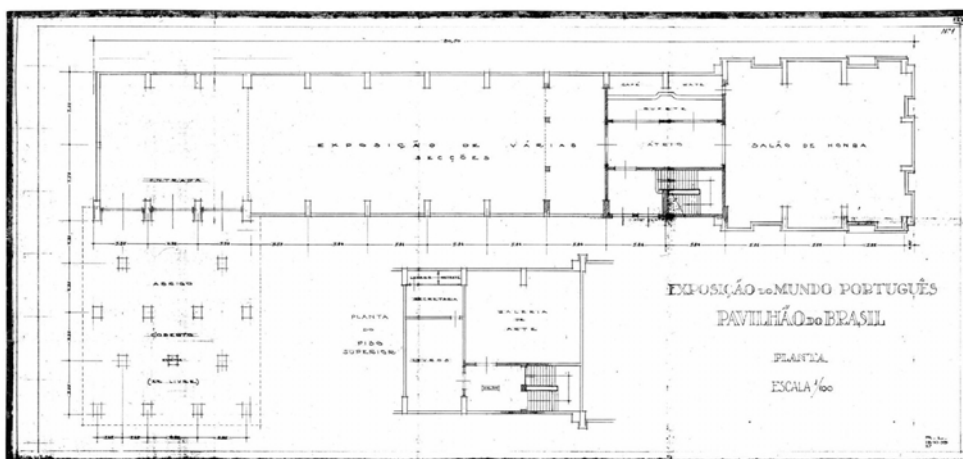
| PAVILHÃO DO BRASIL [PLANTA]
